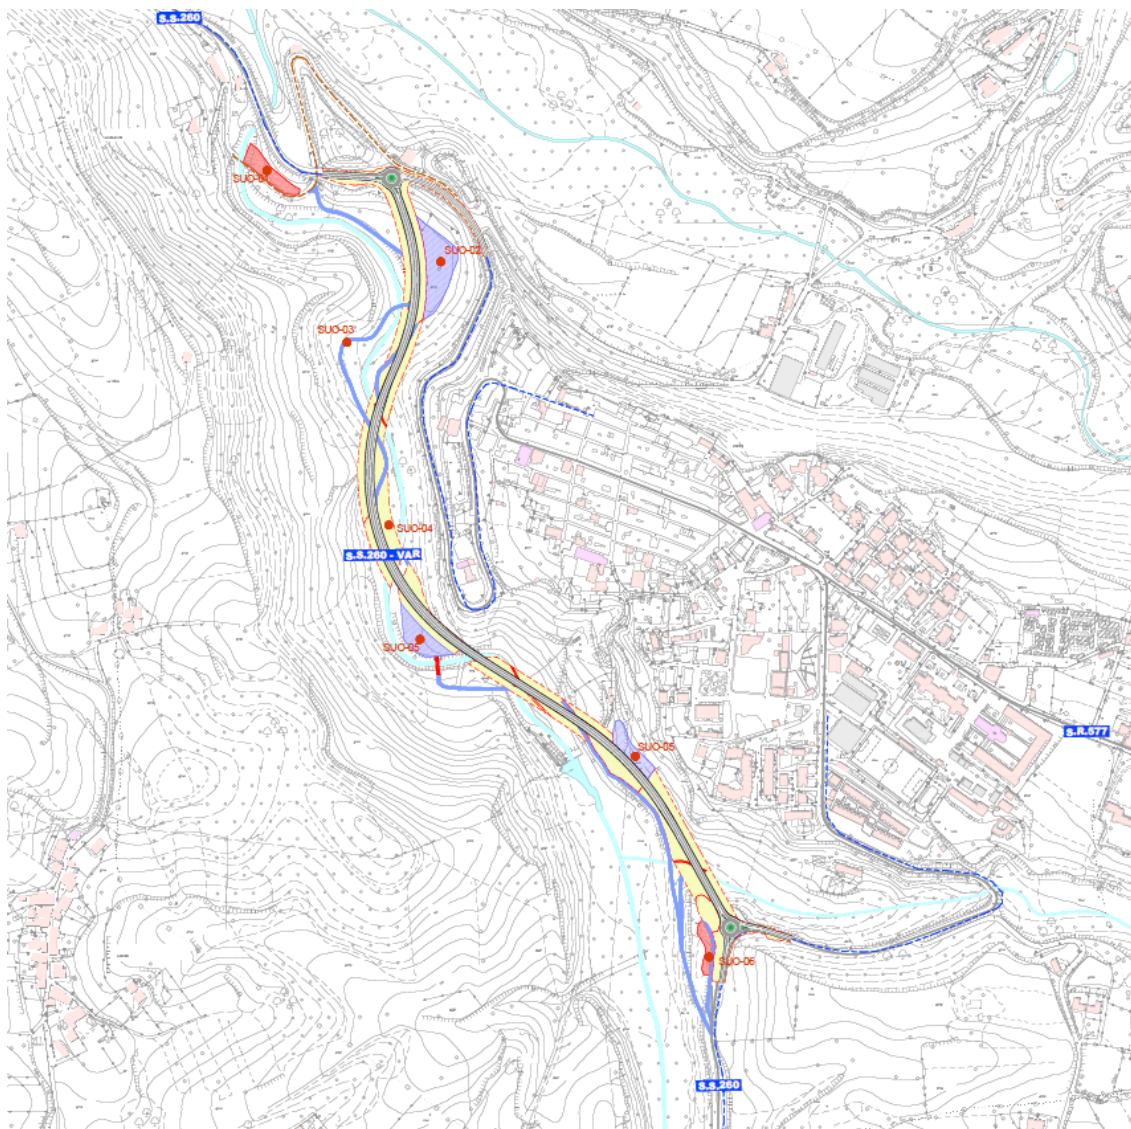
Planimetria punti di monitoraggio componente Suolo
